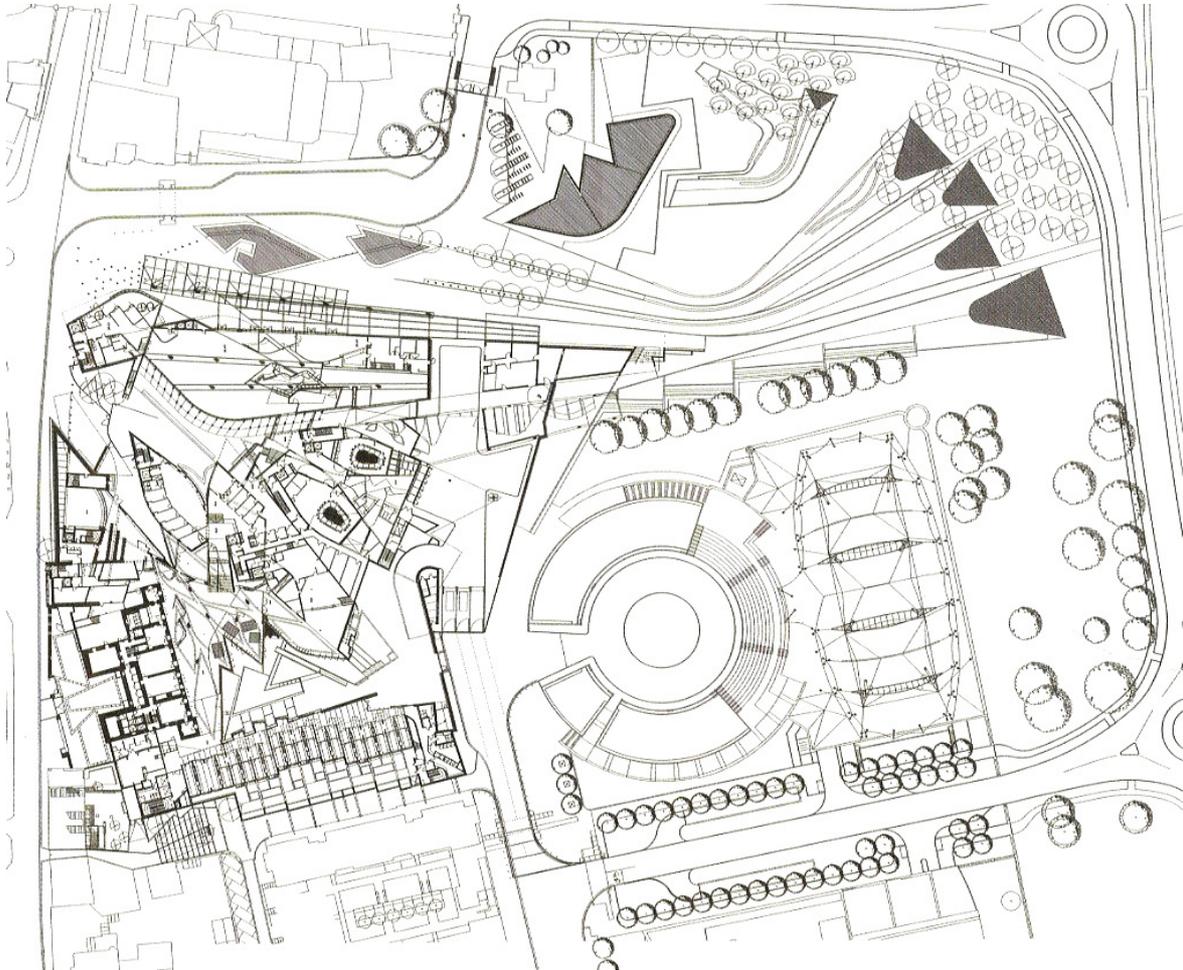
Plano planta General Parlamento de Edimburgo. Escocia.
